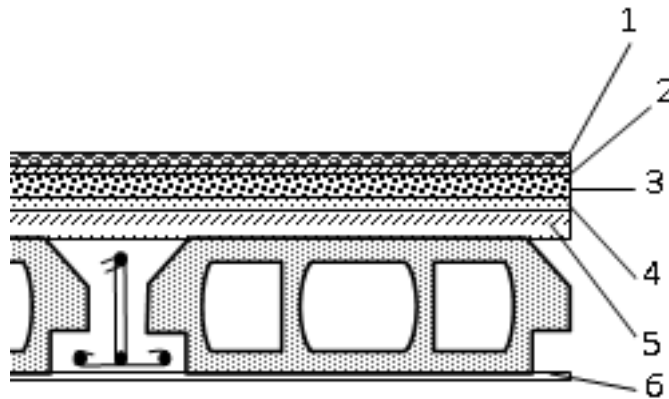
Coupe transversale d'un plancher d'étage courant et du RDC
